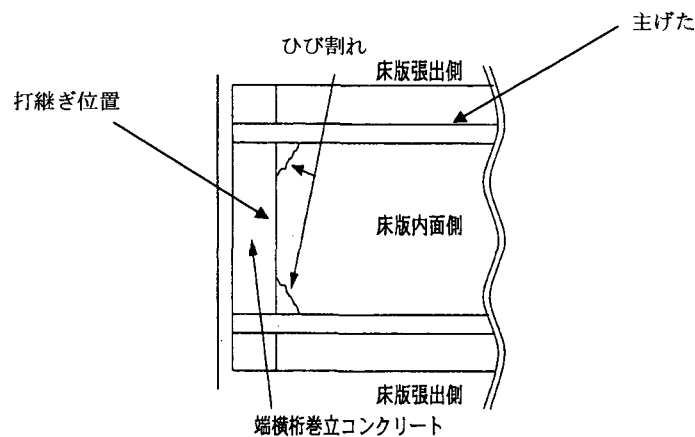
外部拘束ひび割れ模式図 (床版下面)
